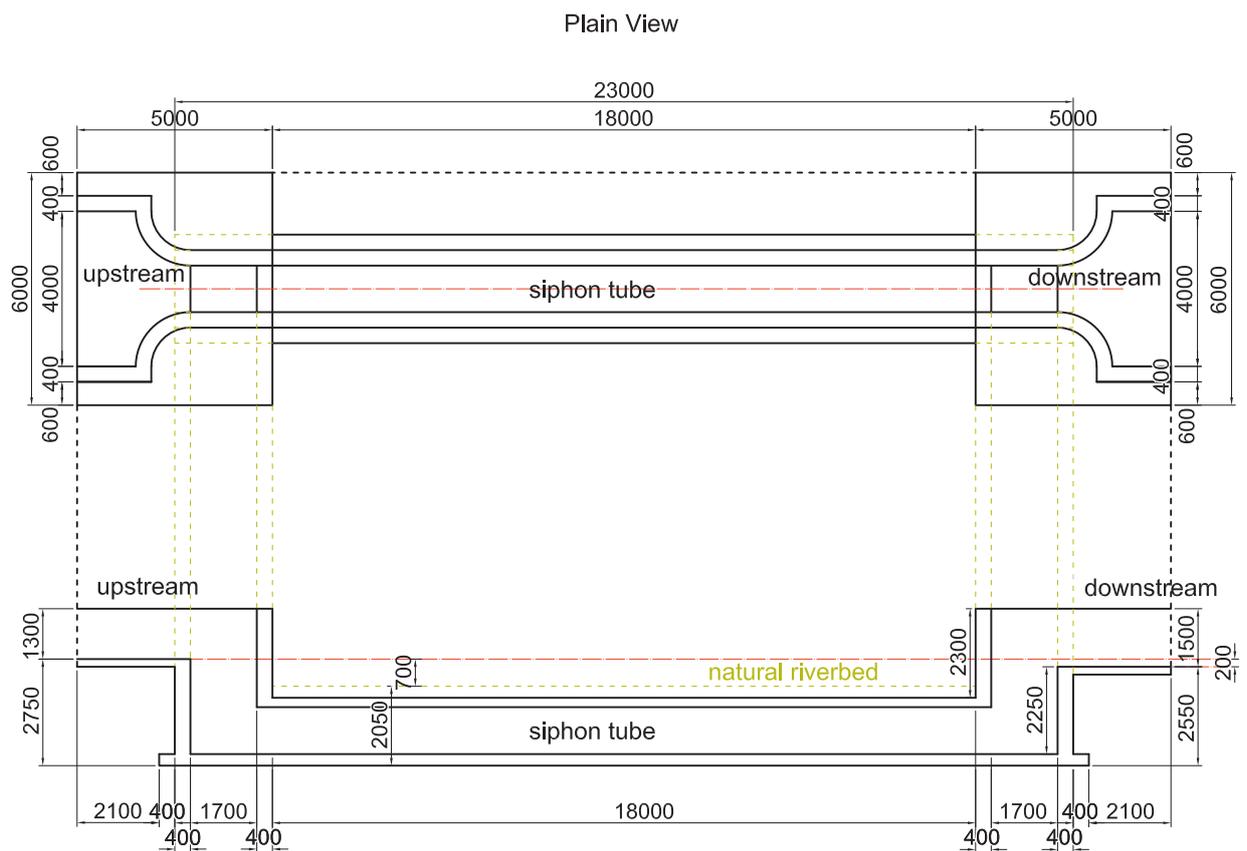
サイフンの平面図および断面図の例<sup>1)</sup>
